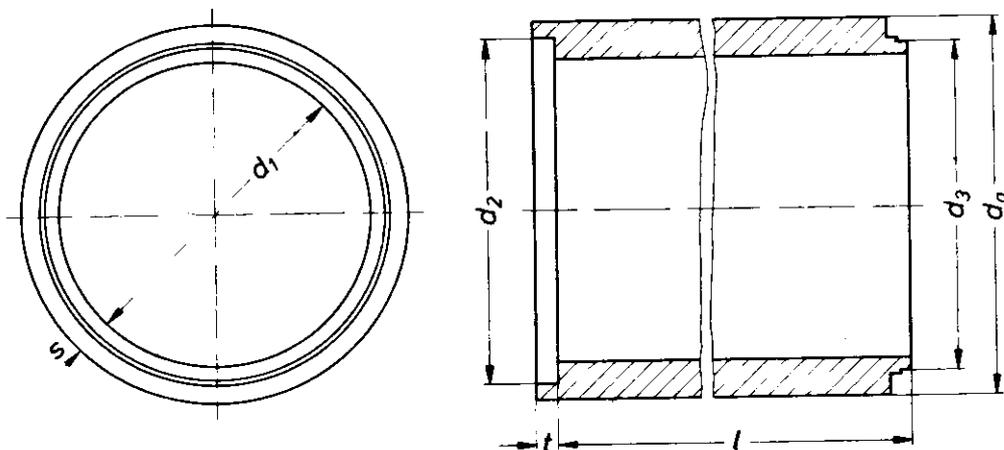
Kreisförmiges Stahlbetonrohr mit Falzmuffe (Form K-FM)
